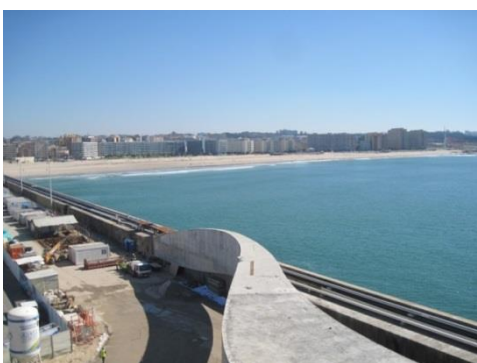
Pala dos autocarros estruturalmente já terminada.
